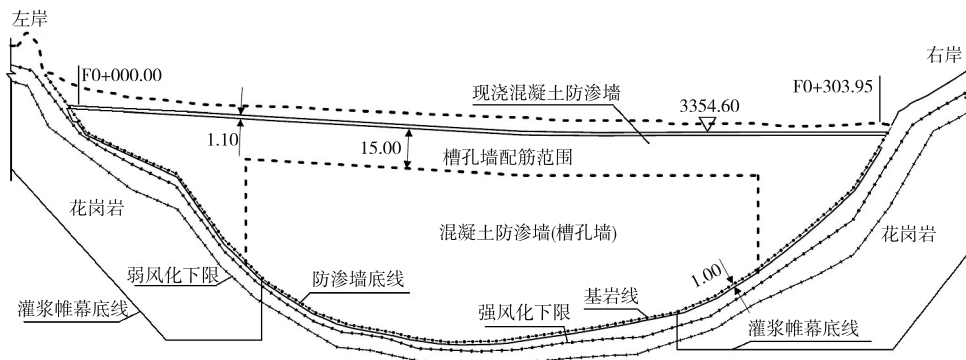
大坝混凝土防渗墙纵剖面图(单位: m)
